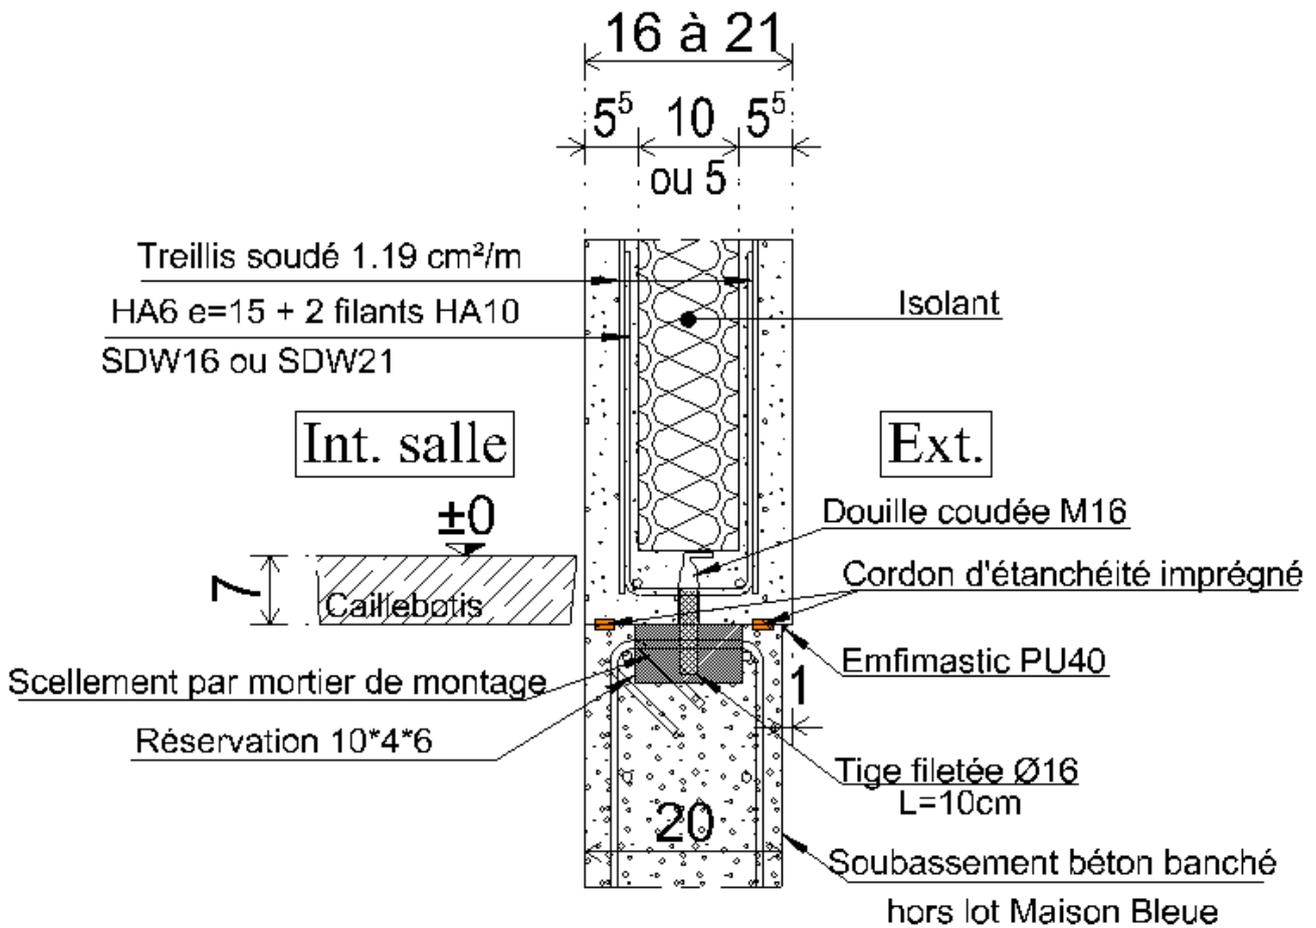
Panneaux sandwichs de façade posés sur soubassement – traitement de joint vertical
